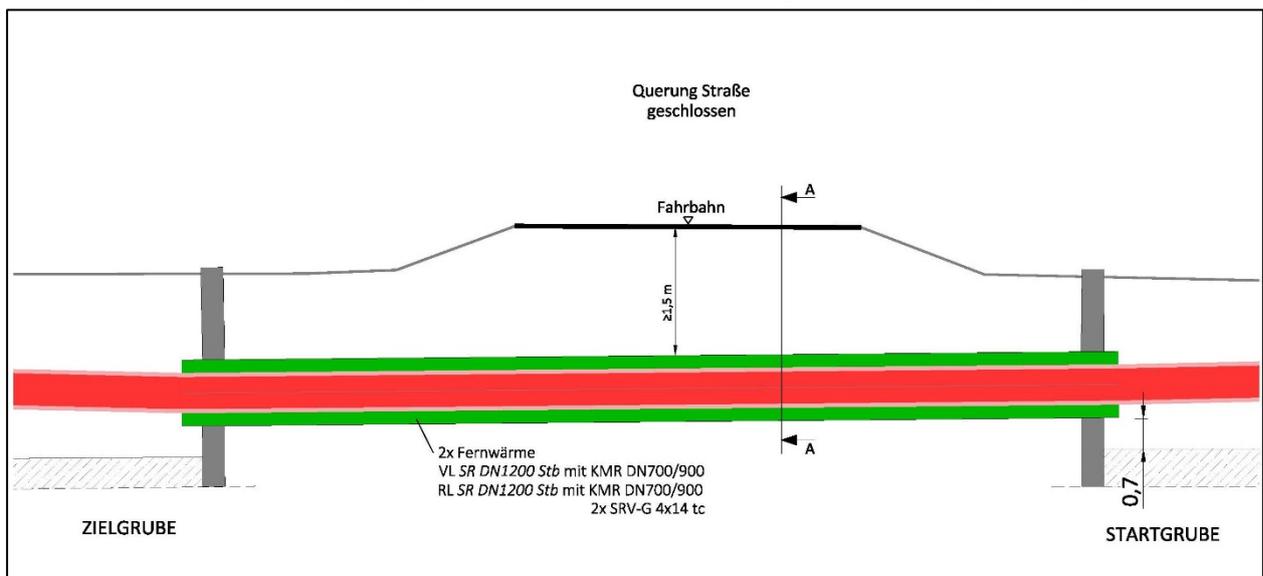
Typenplan Straßenquerung in geschlossener Bauweise
